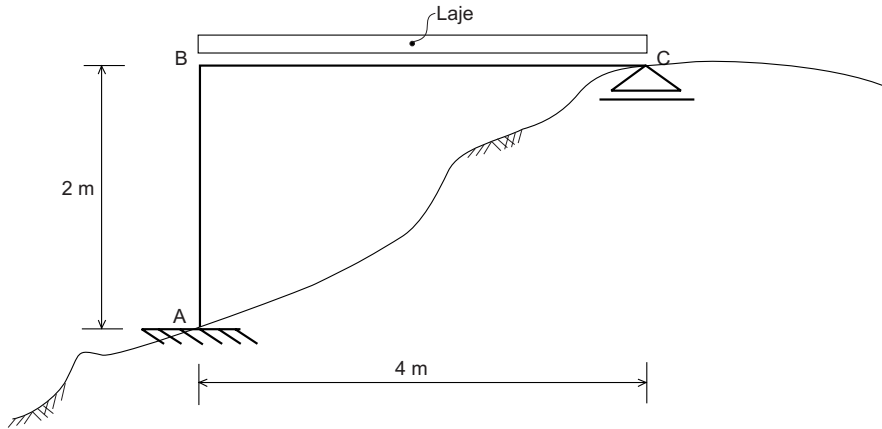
Representação esquemática da estrutura metálica de apoio da laje de piso.
